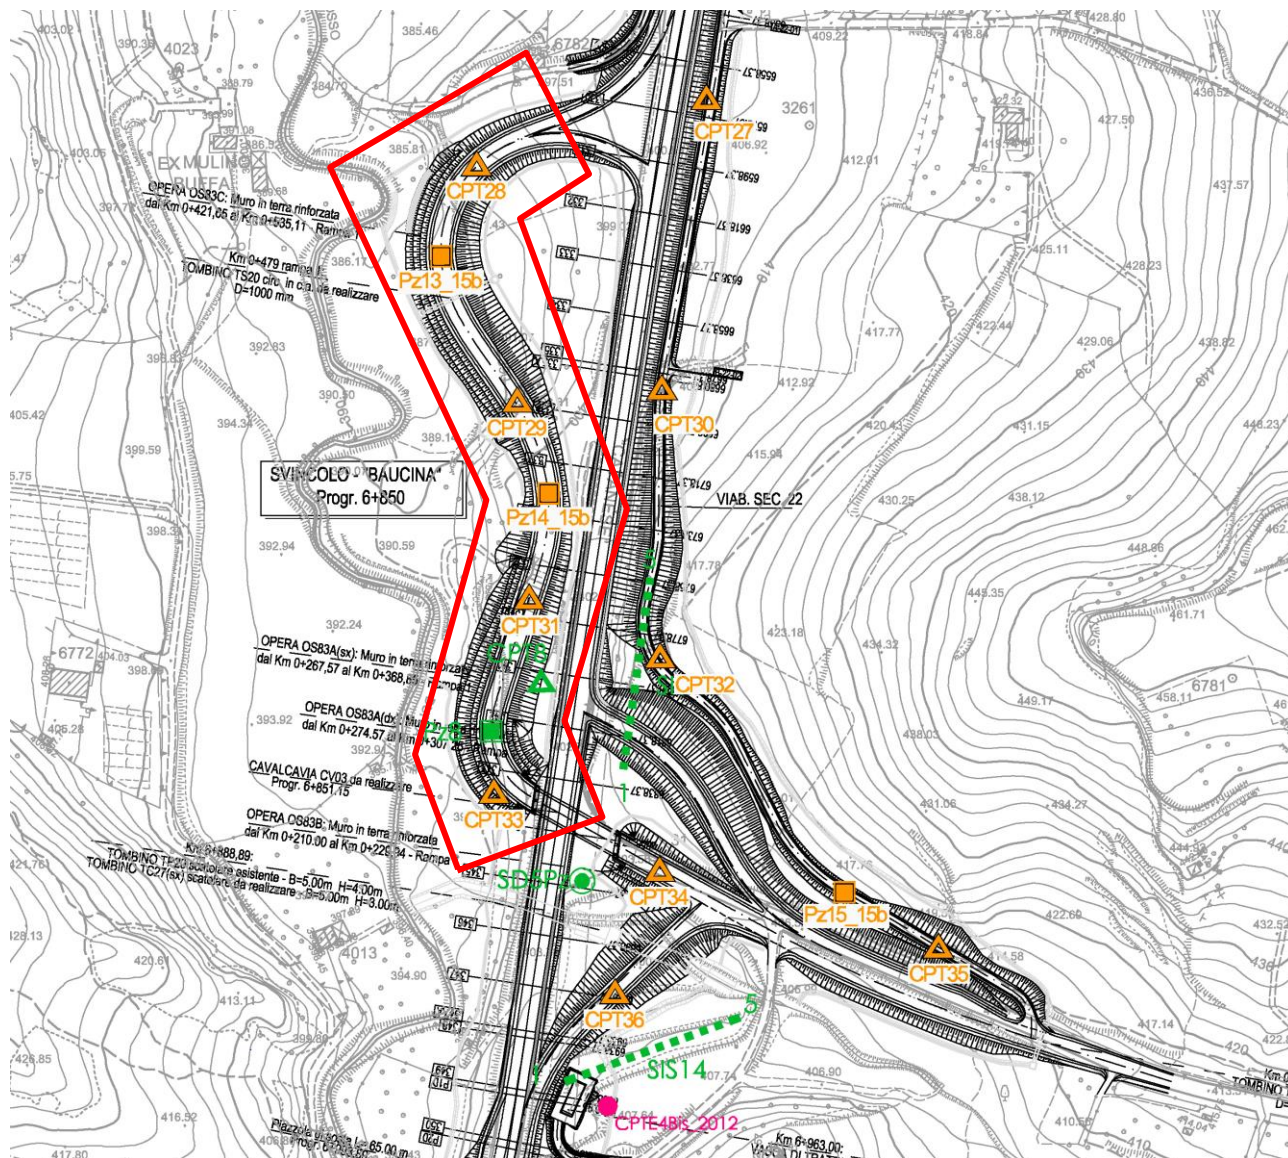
Planimetria con ubicazione indagini geotecniche disponibili.
